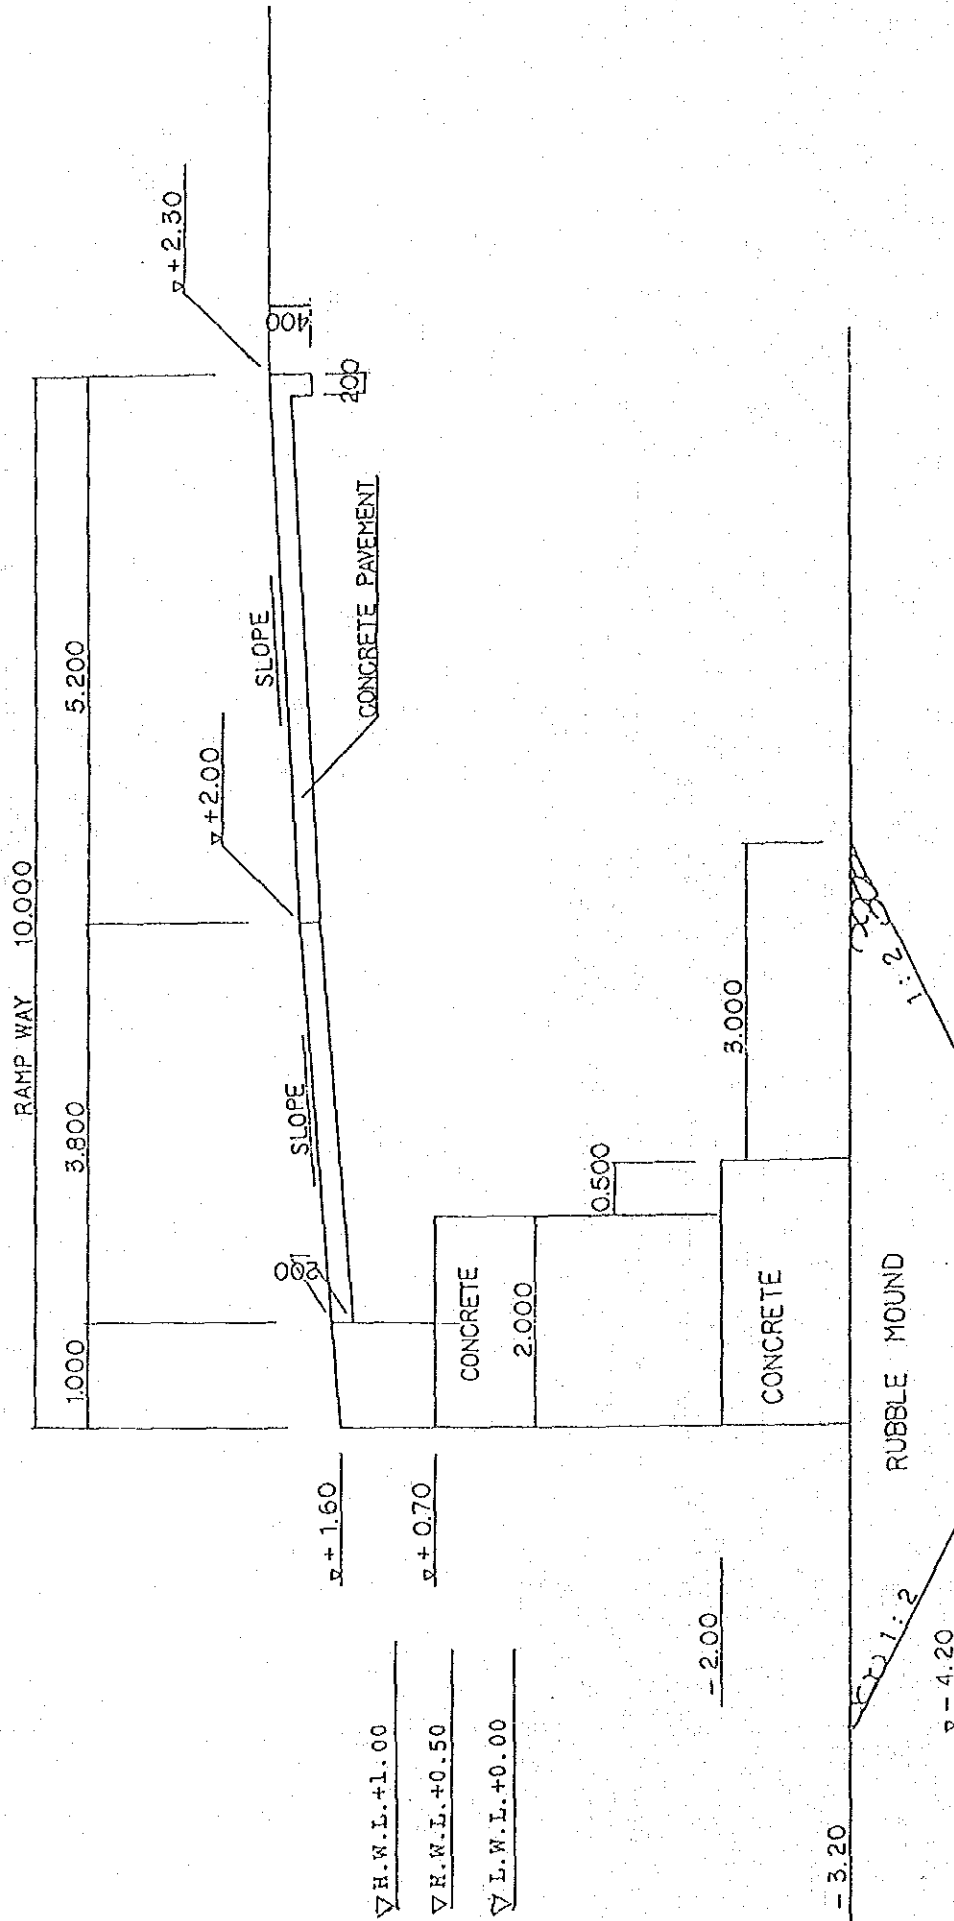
(1) ムリファヌア港フェリーランプ復旧標準断面図
